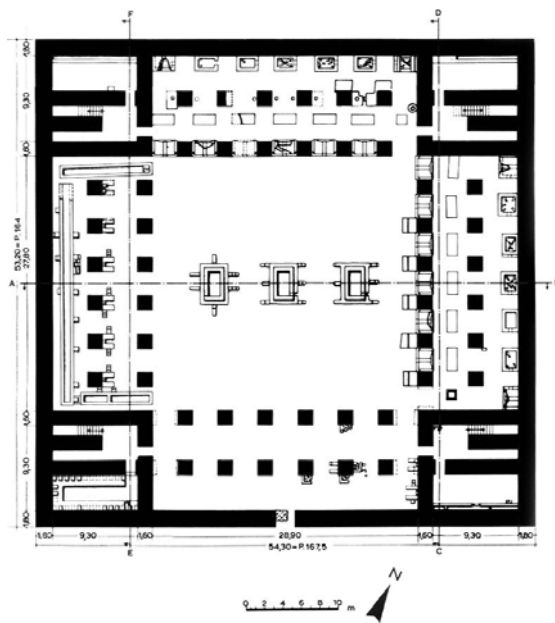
Grundriss Anlage von Dahana-i Ġulāmān
